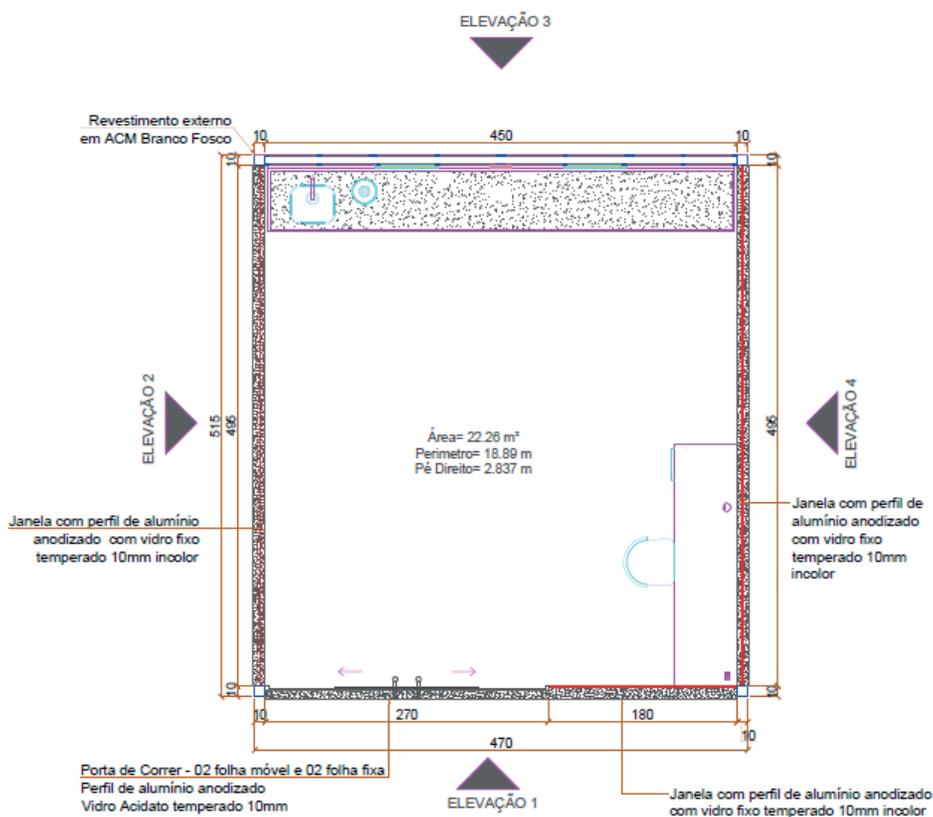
Planta baixa do projeto modular em estudo com indicação das elevações e cotas em centímetros
